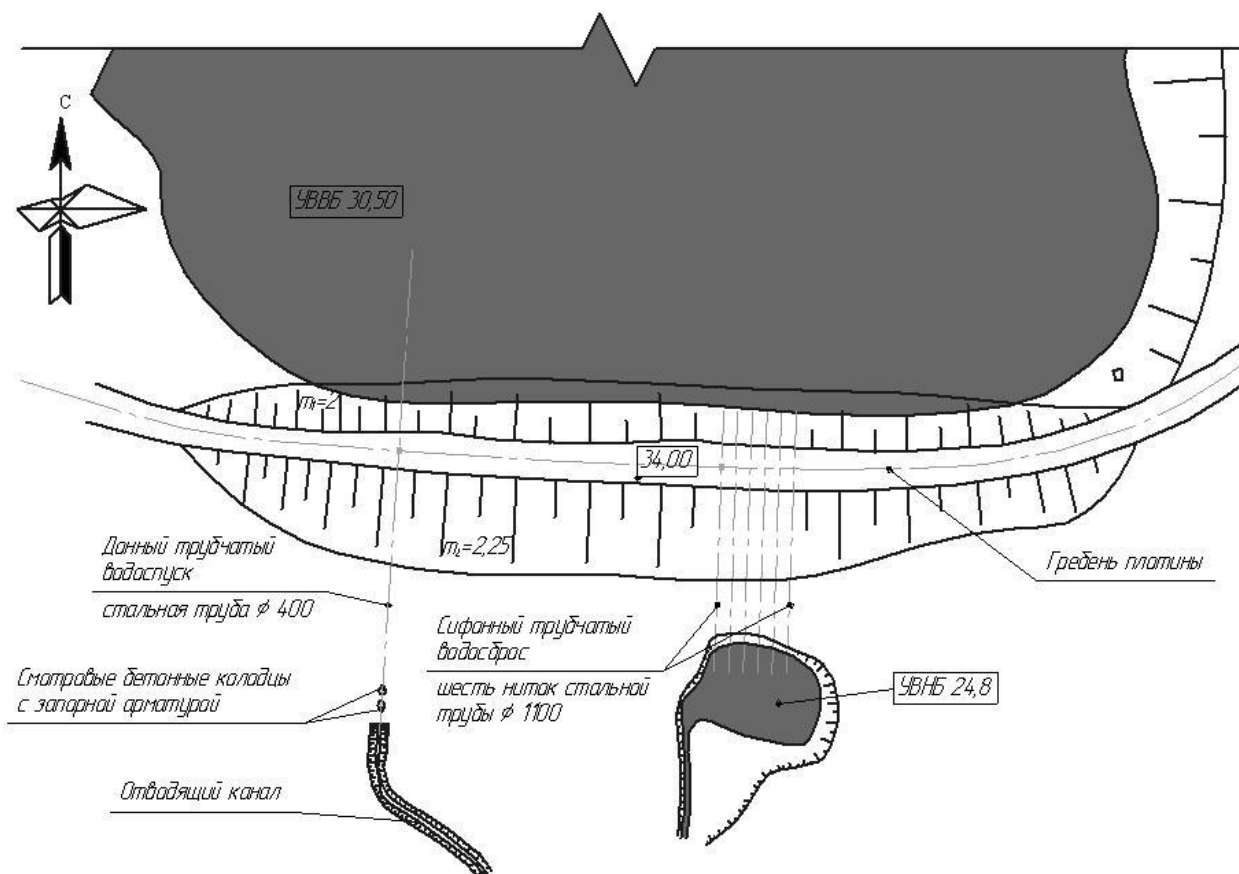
Схема гидроузла на балке Калмыцкая
